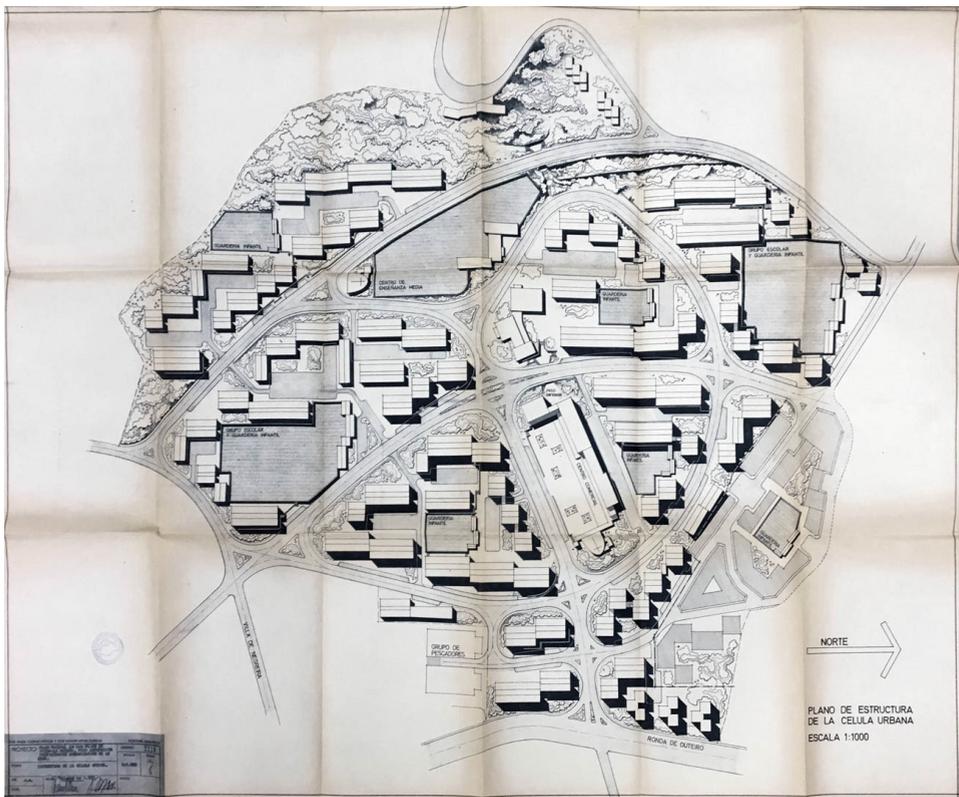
Plano General Plan Parcial de Visma. Fuente: Archivo General de Fomento.
